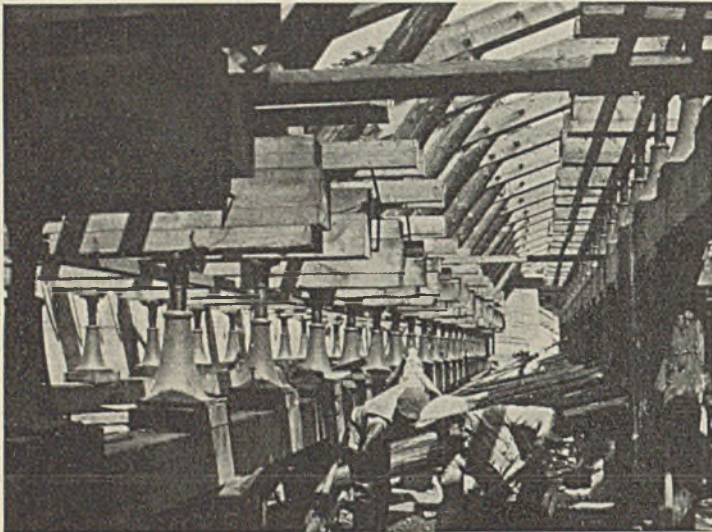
Lehrgerüst der äußeren Ludwigsbrücke.
